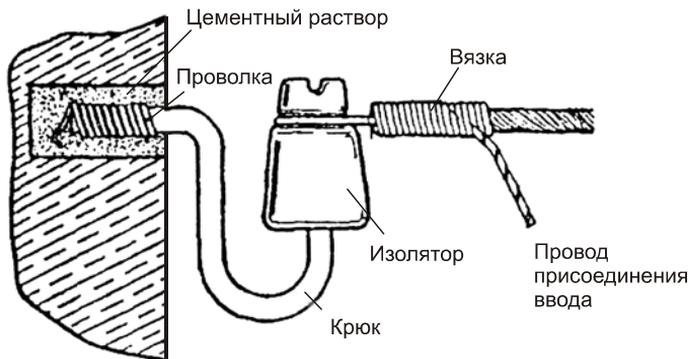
Крепление фарфорового изолятора к бетонной стене дома
